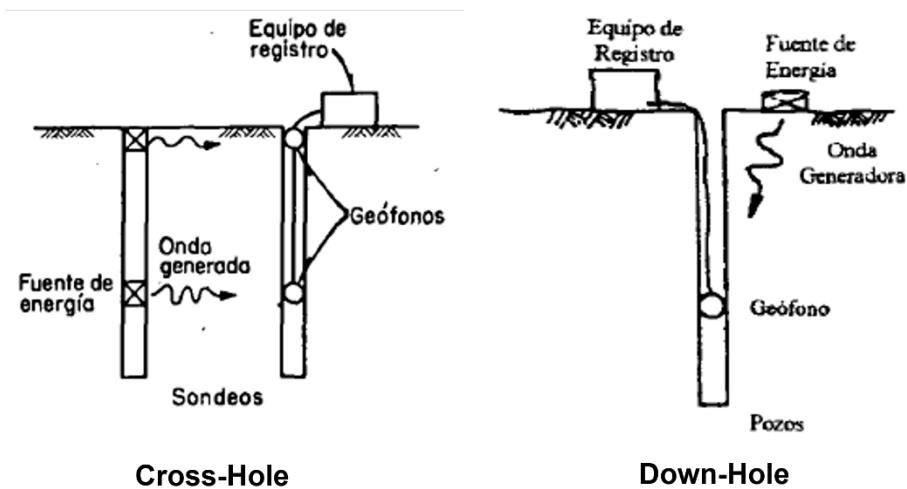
Pruebas en pozos (Jaime, 1987)
